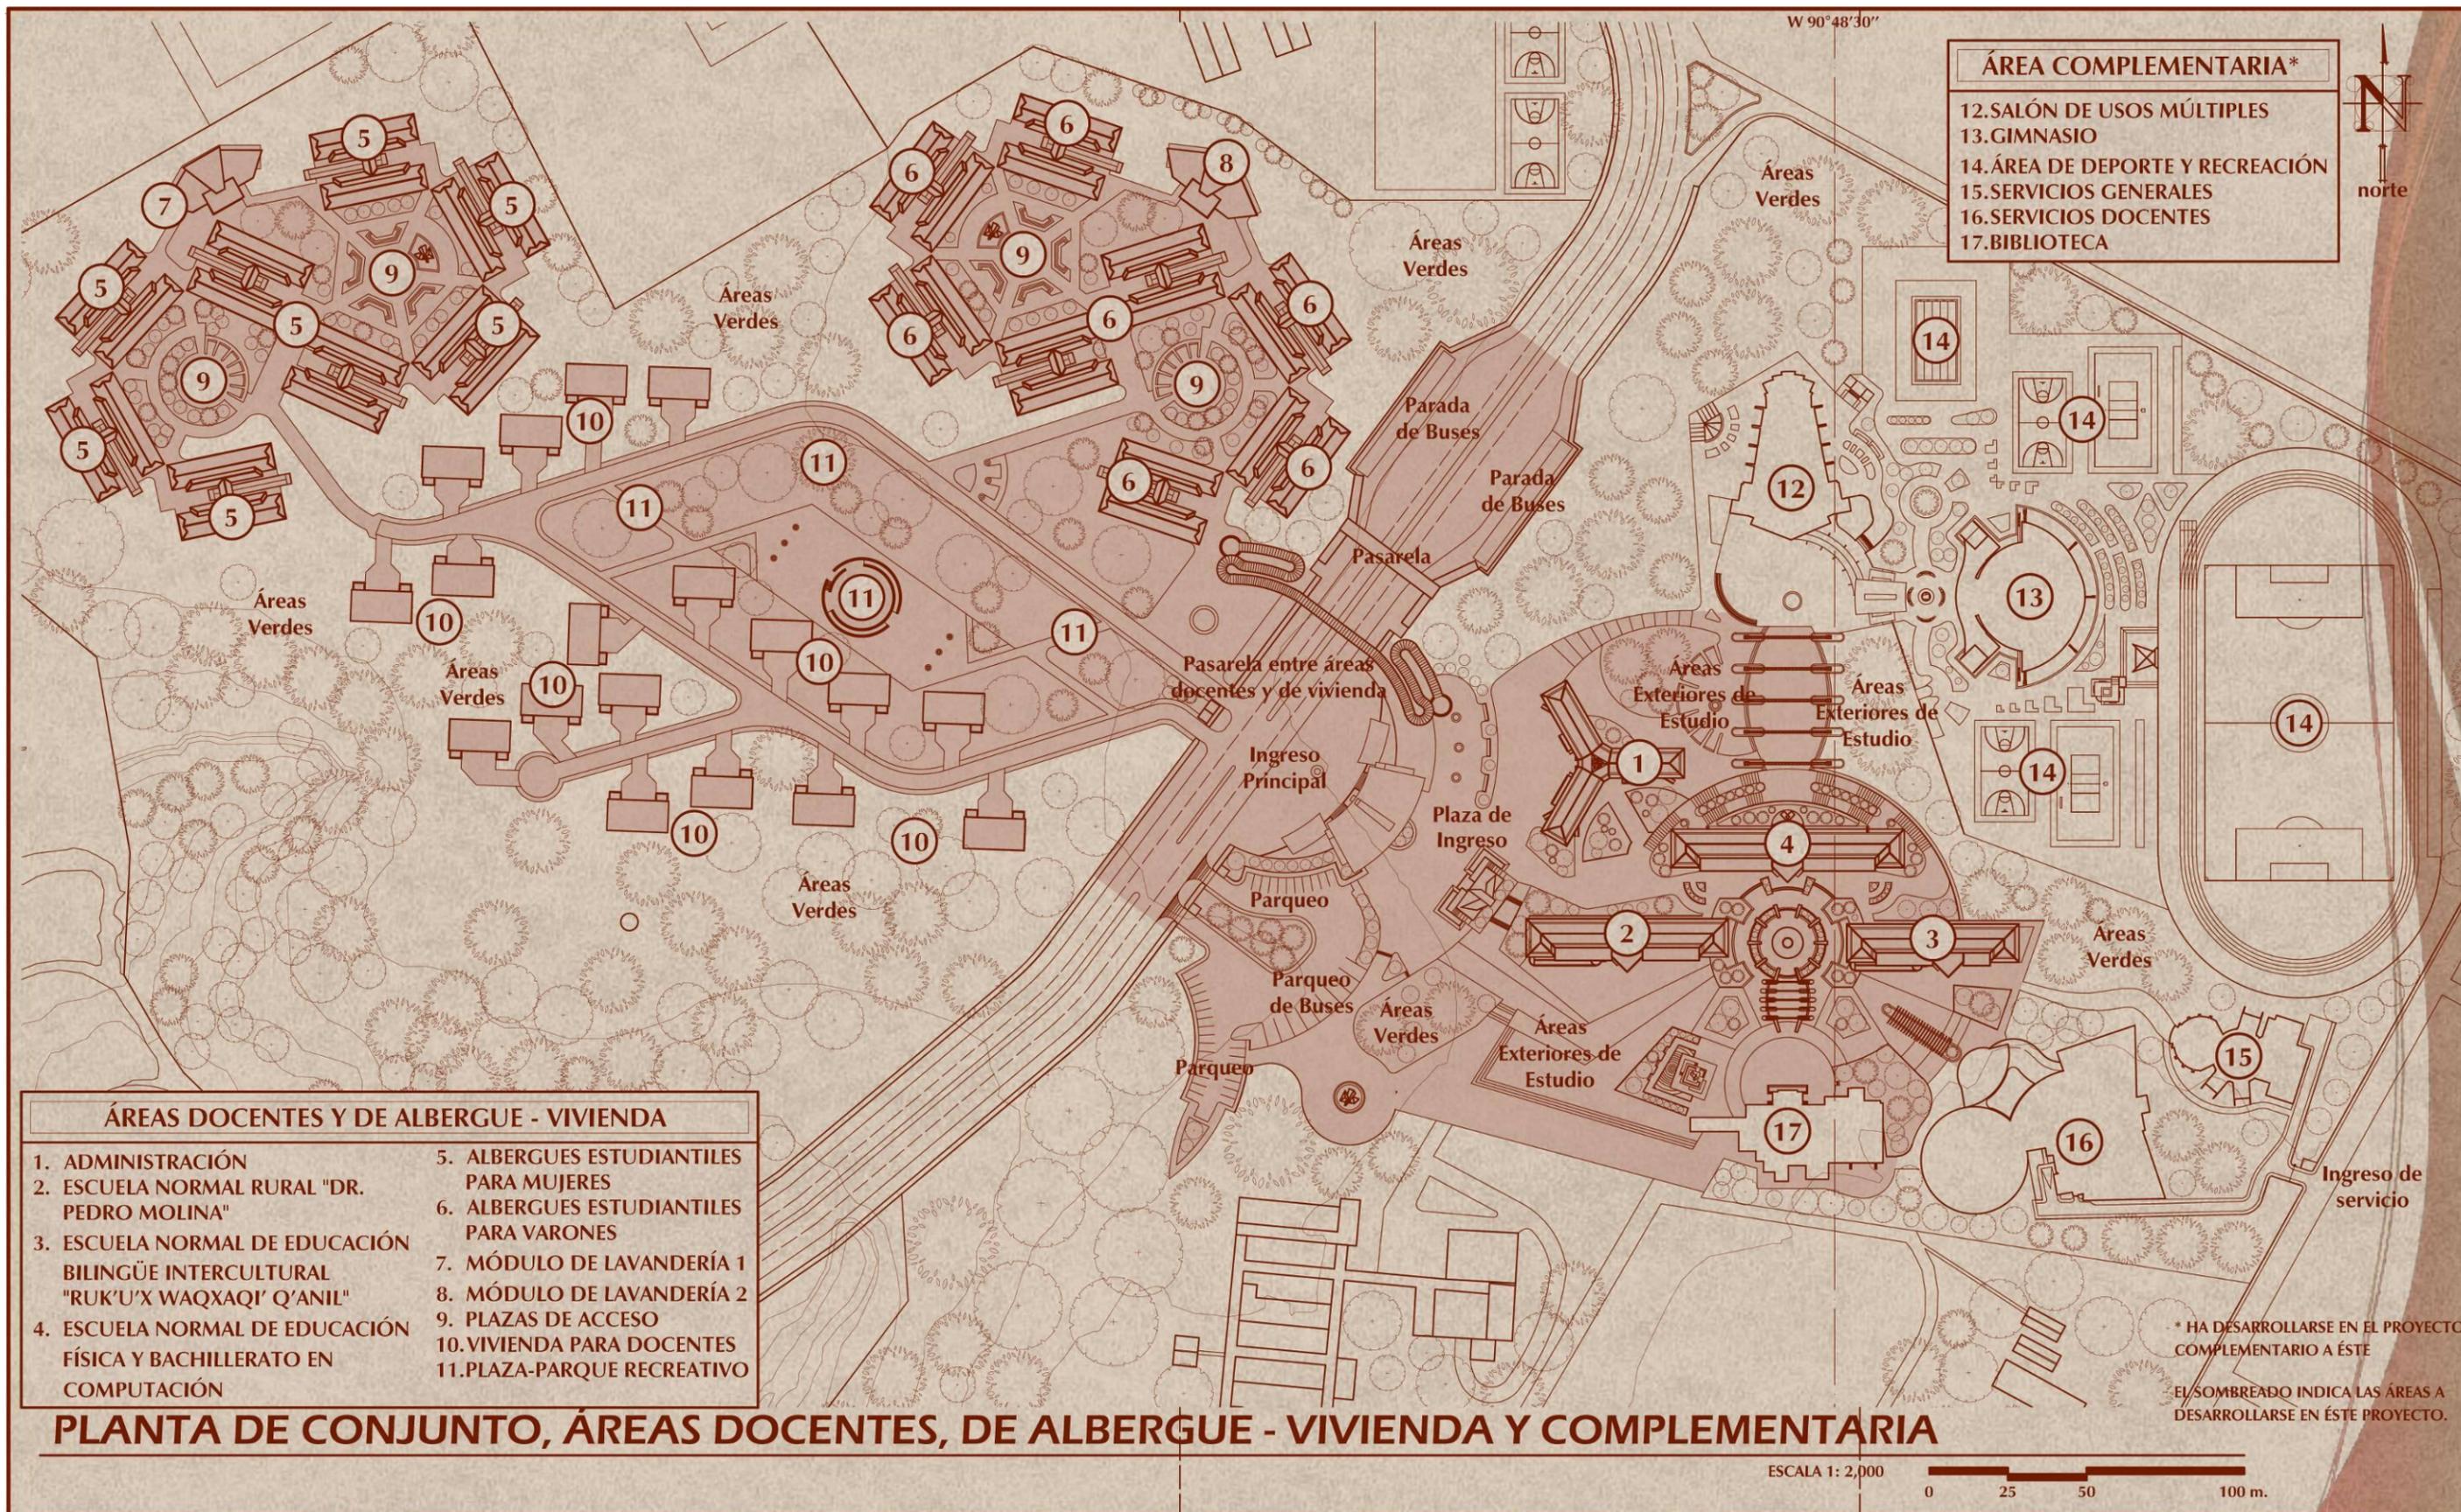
Propuesta del Anteproyecto en Planta de Conjunto por áreas. Elaboración Propia.
